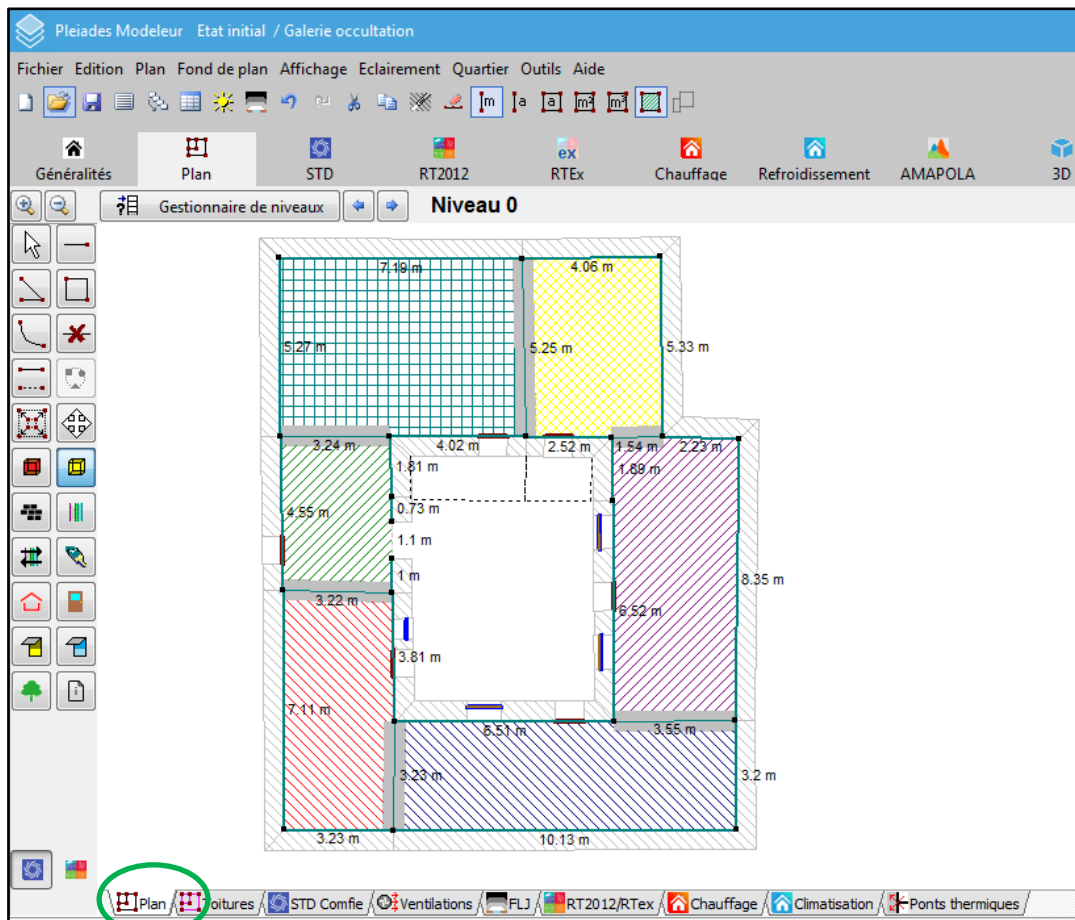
Plan du Niveau 0 (RDC) de la maison dans Pleiade.
